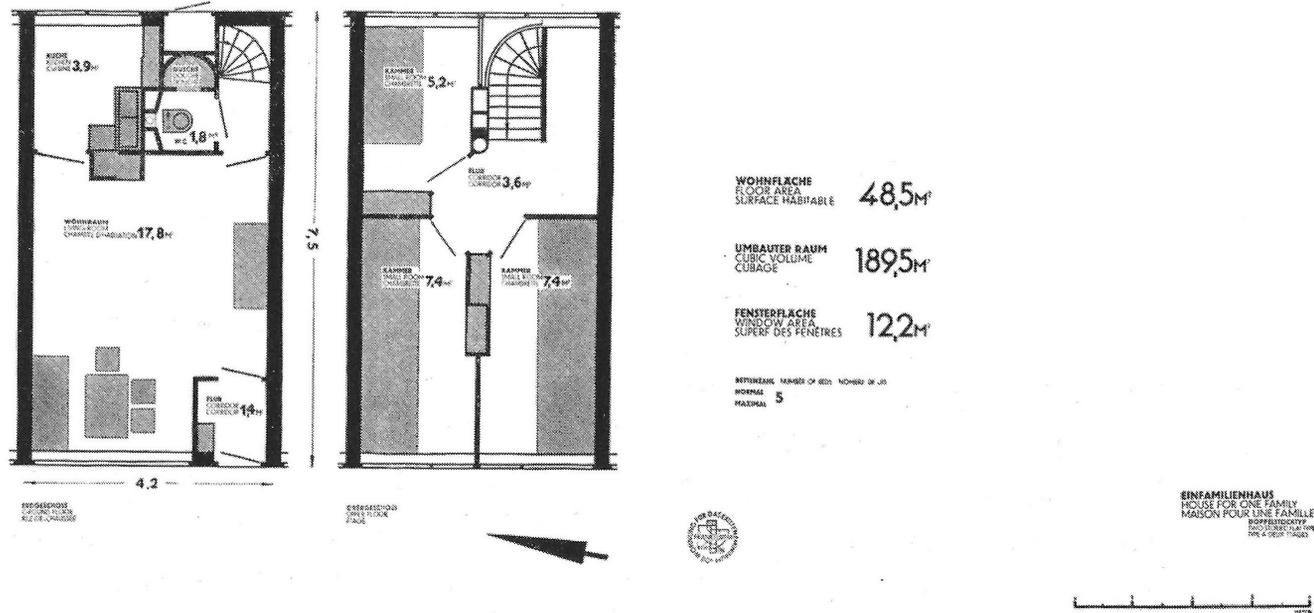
Grundrissentwurf von Pieter Oud.
